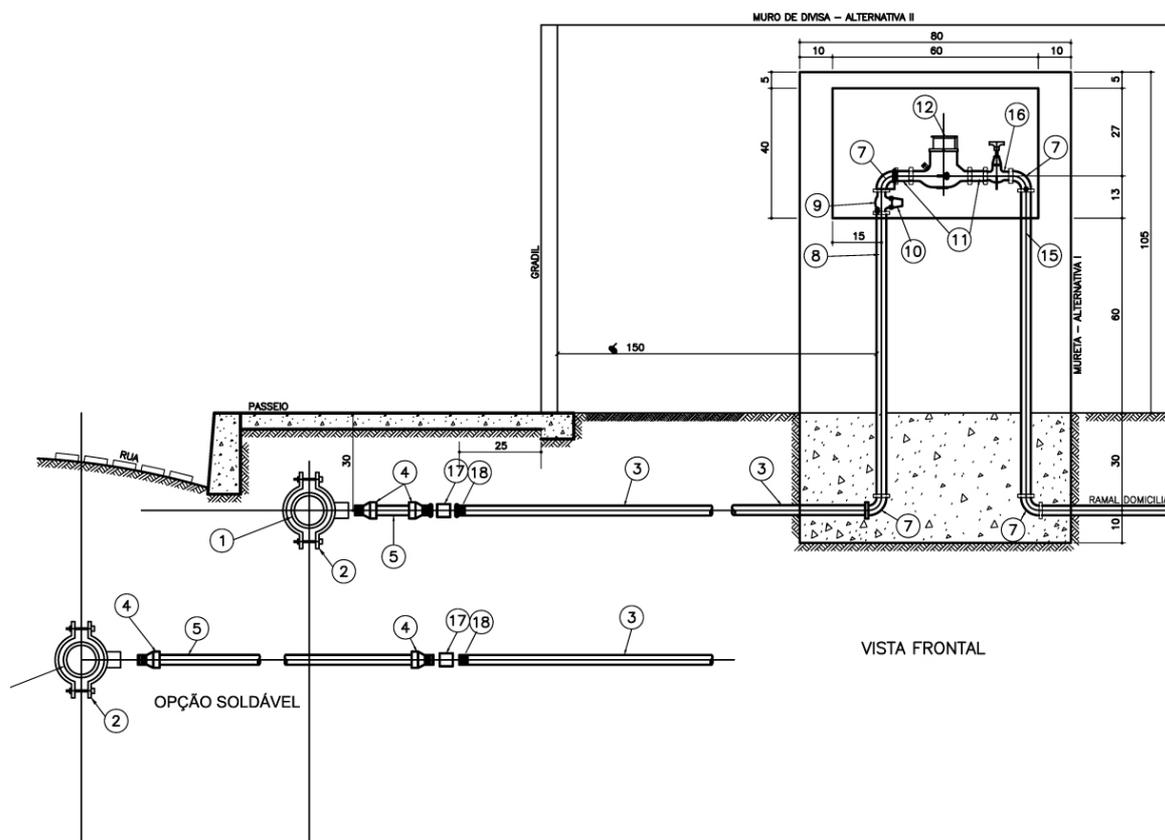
instalação do padrão COPASA embutido em muro ou mureta-Vista frontal
